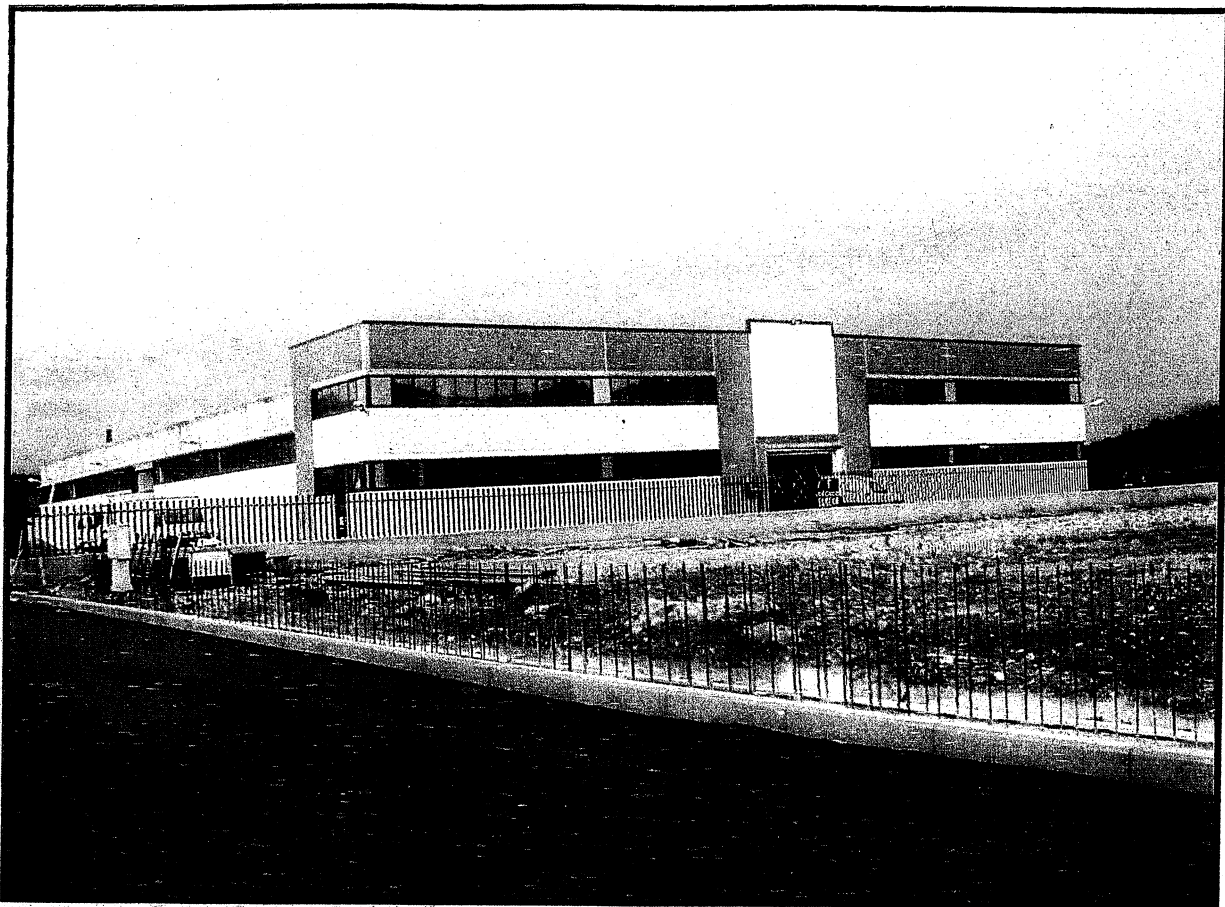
Vista dalla strada interna di lottizzazione n°2
